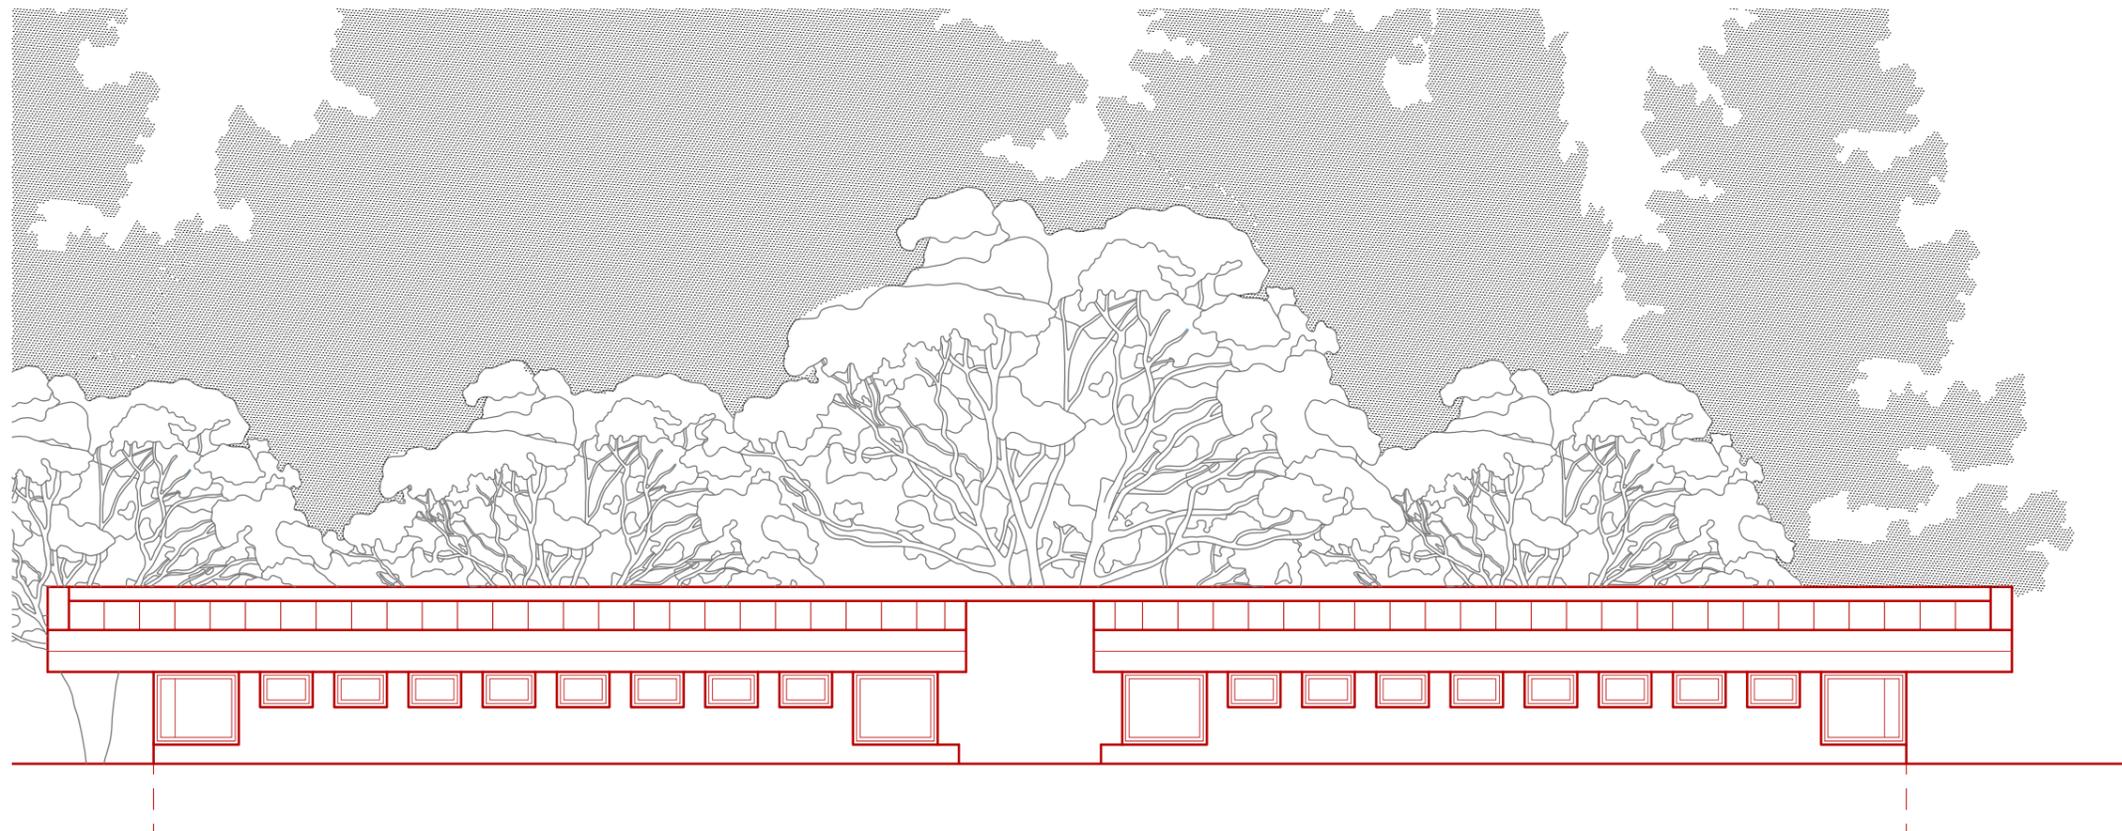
Alçado Poente Instalações Sanitárias entrada Sul
